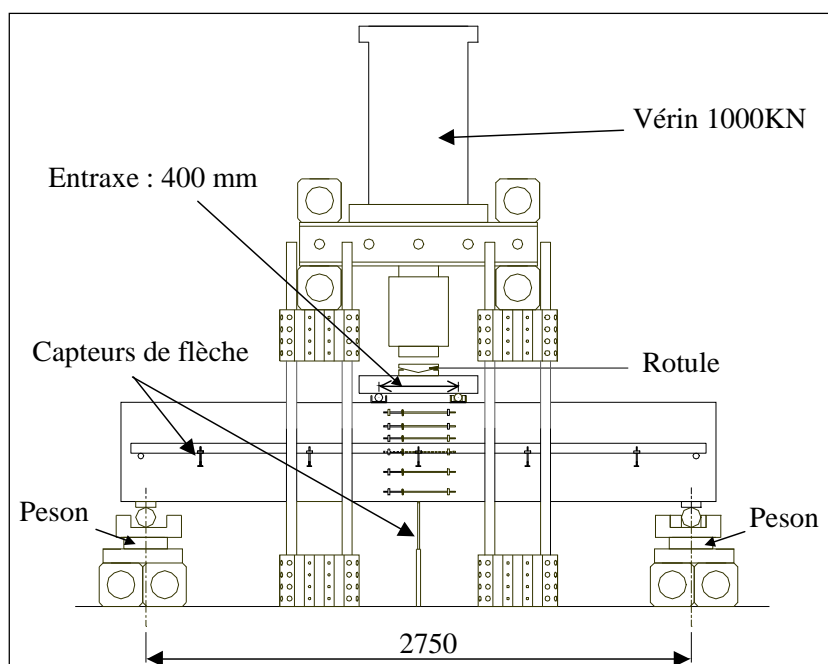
Schéma mécanique pour l'essai de rupture des poutres
